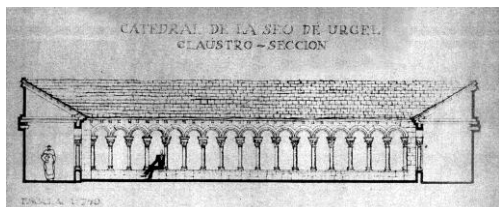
Seo de Urgel. Catedral de Santa María Ala Sur del Claustro. AAFV. Plano de proyecto. A. Ferrant Estado actual. Fotografía de la autora. 2011
